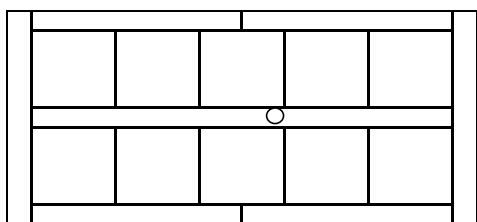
b: Installation murale 500 avec conduits d'air en béton léger fibre de verre.
